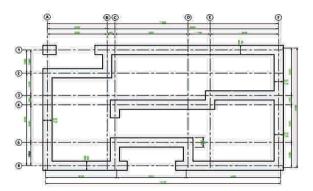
24: Plano de excavaciones de la vivienda prototipo.
